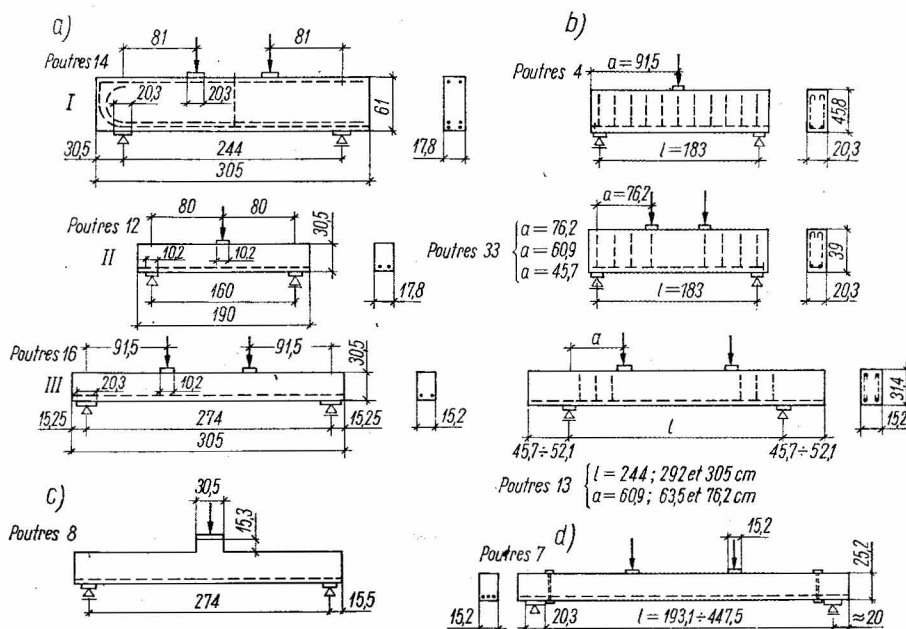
Poutres en béton armé examinées dans les essais américains: a) poutres étudiées par MOODY, VIEST, ELSTNER et HOGNESTAD, b) poutres étudiées par CLARK, c) poutres étudiées par LAUPA, SIESS et NEW-MARK, d) poutres étudiées par FELDMANN et SIESS
